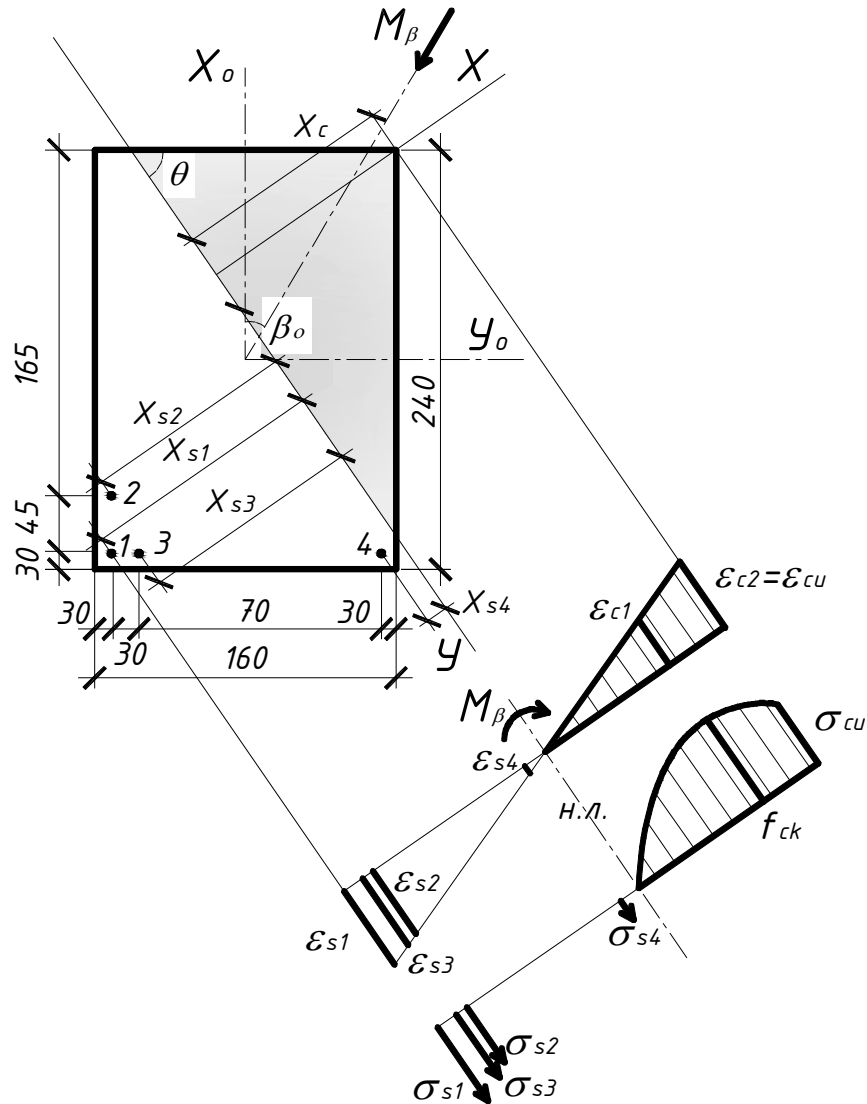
Розрахункова схема перерізу косозігнутої залізобетонної балки до прикладу Г.3
